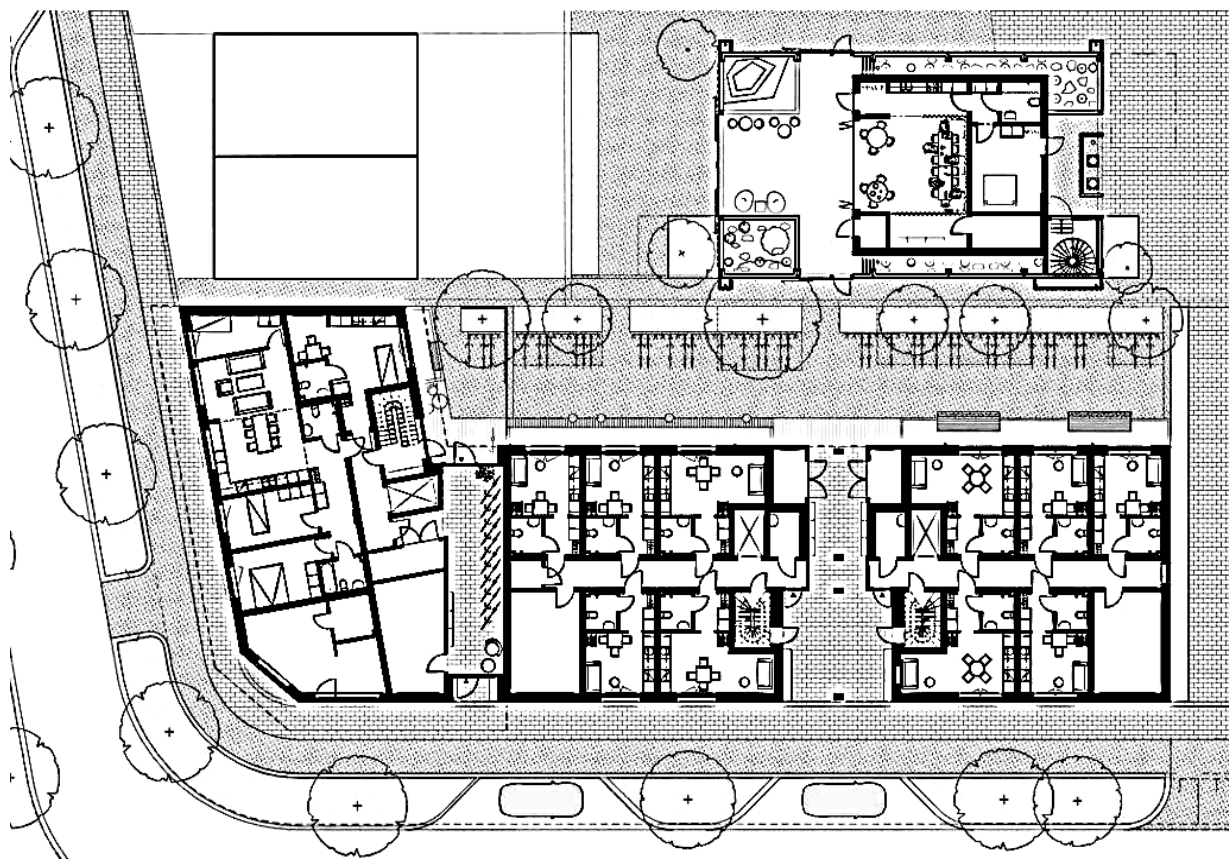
Планувальне вирішення першого поверху житлового будинку – колівінг, Лінченінг, Швеція (Archdaily, 2025)
